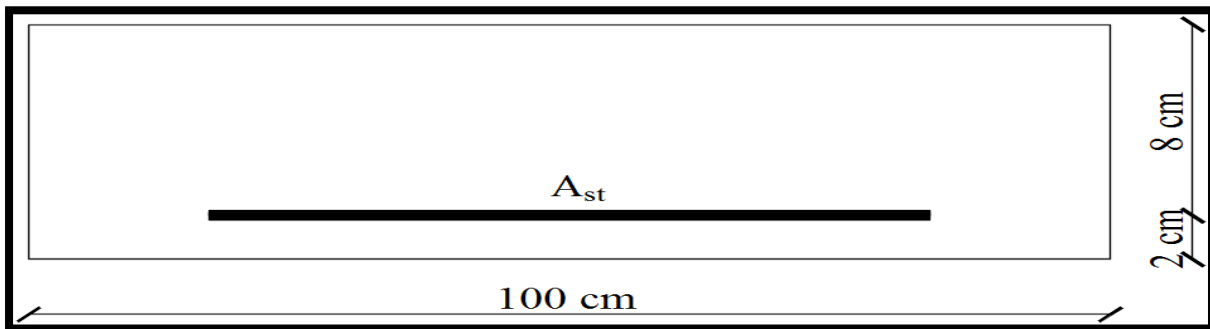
Schématisation (2D) de la section longitudinale de l'acrotère.
